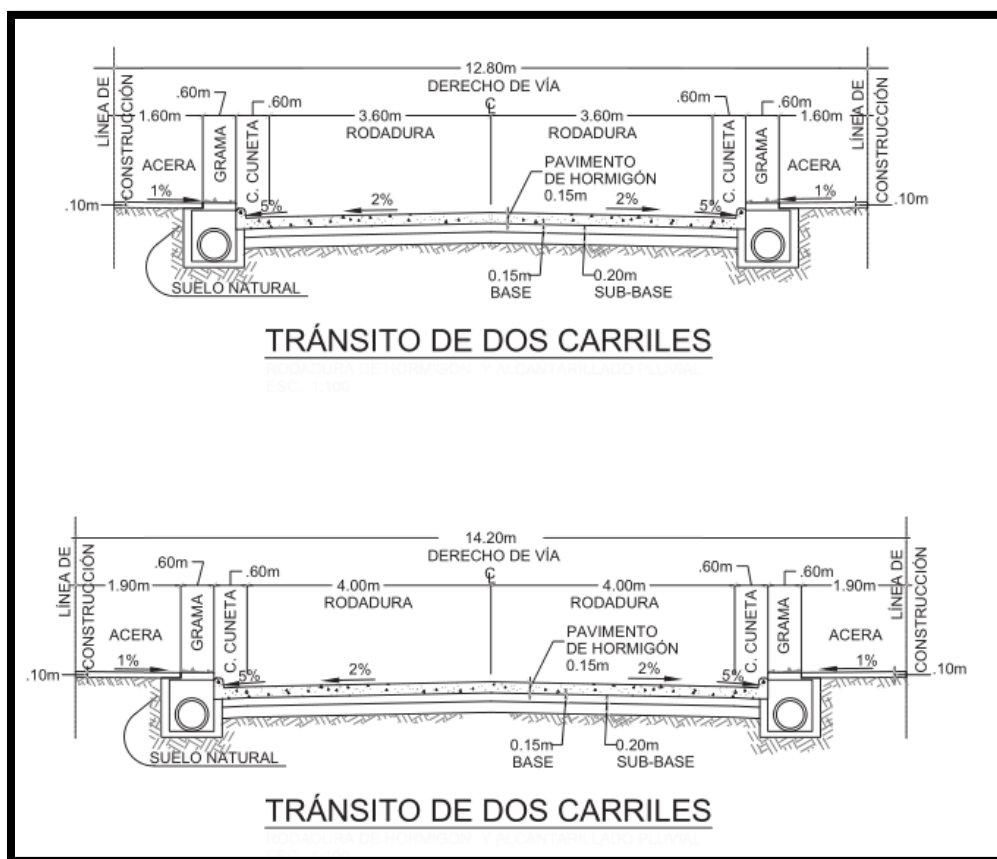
Planta vial servidumbre de 12.80 y 14.20
